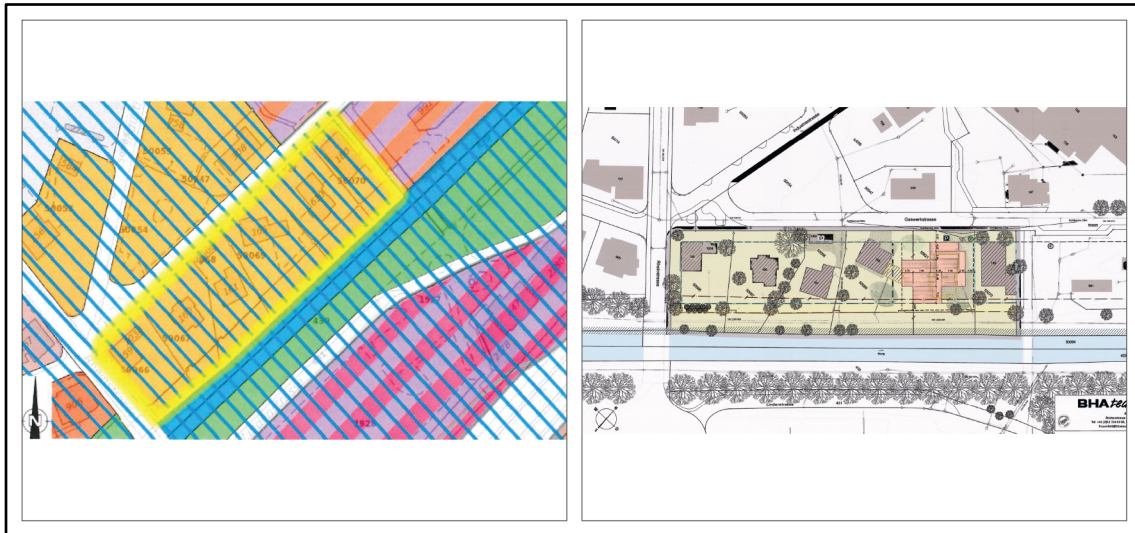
GP "Gaswerkstrasse", Zonenplan (links) und Gestaltungsplan (rechts) (BHAtteam Ingenieure AG, 2016b)
